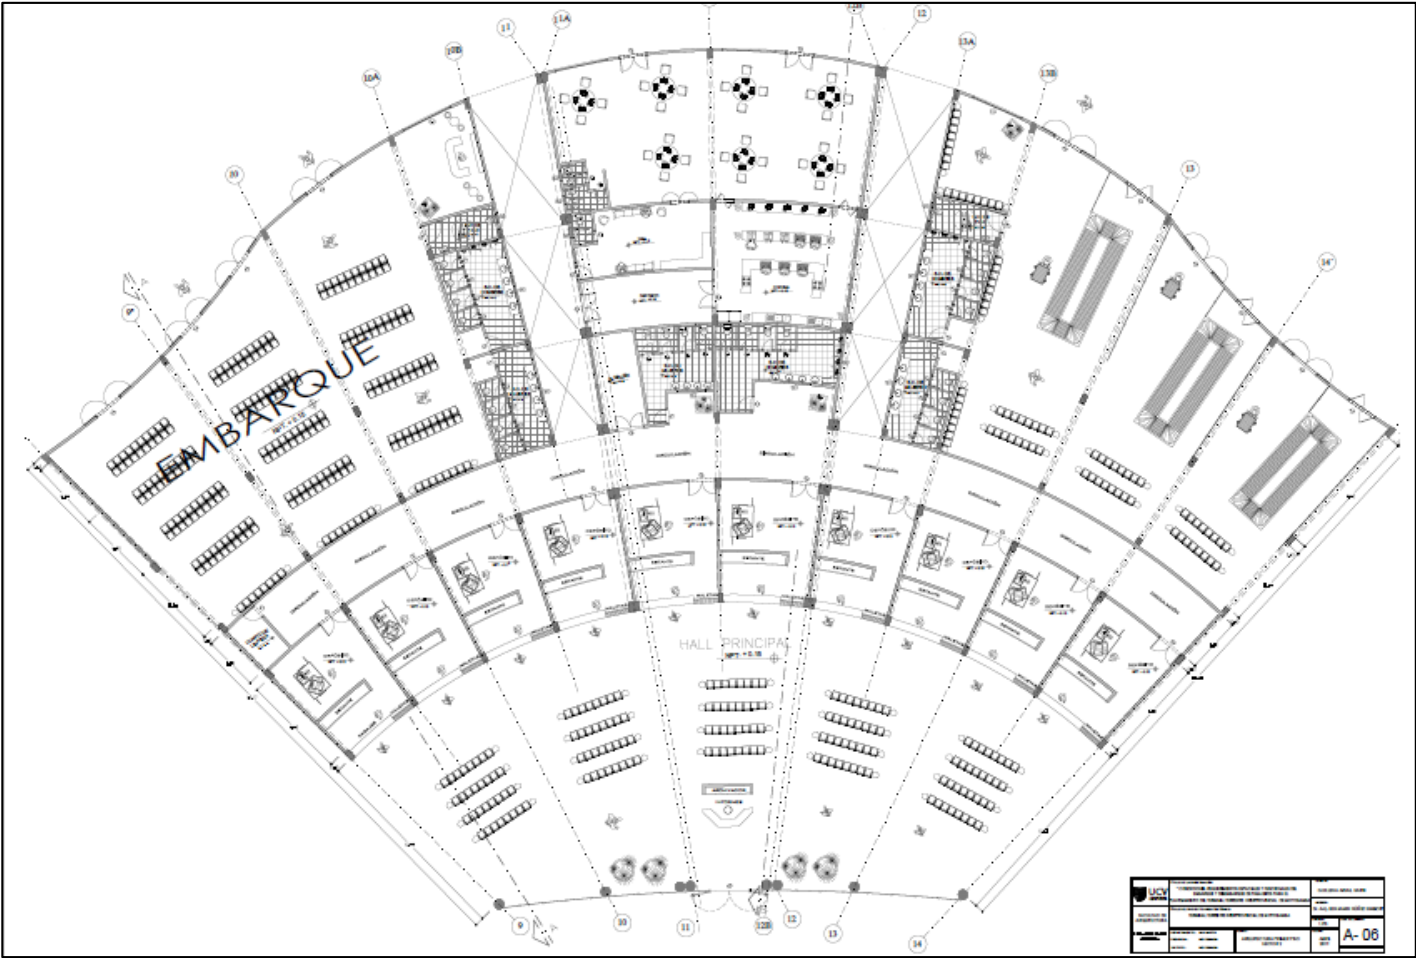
Plano bloque 2, Fuente: Elaboración propia.
